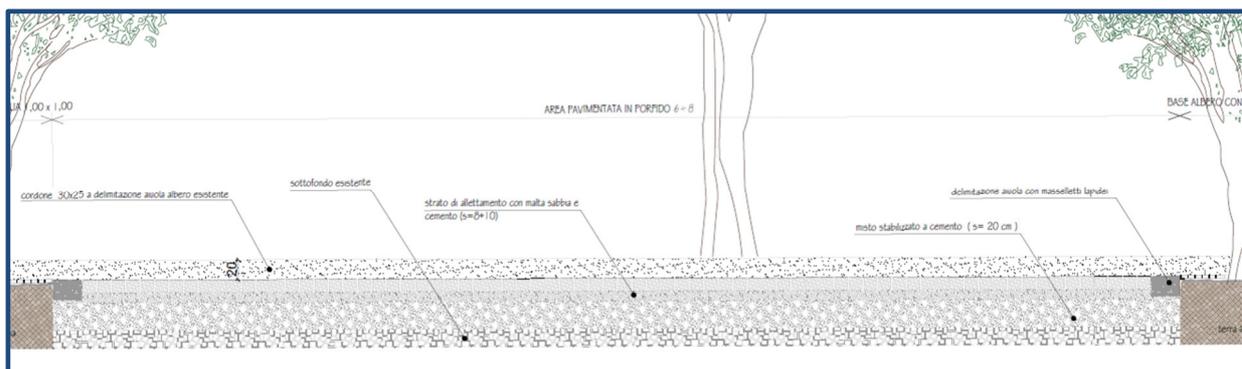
Lotto 1 Piazza stratigrafia di progetto pavimentazione in porfido
